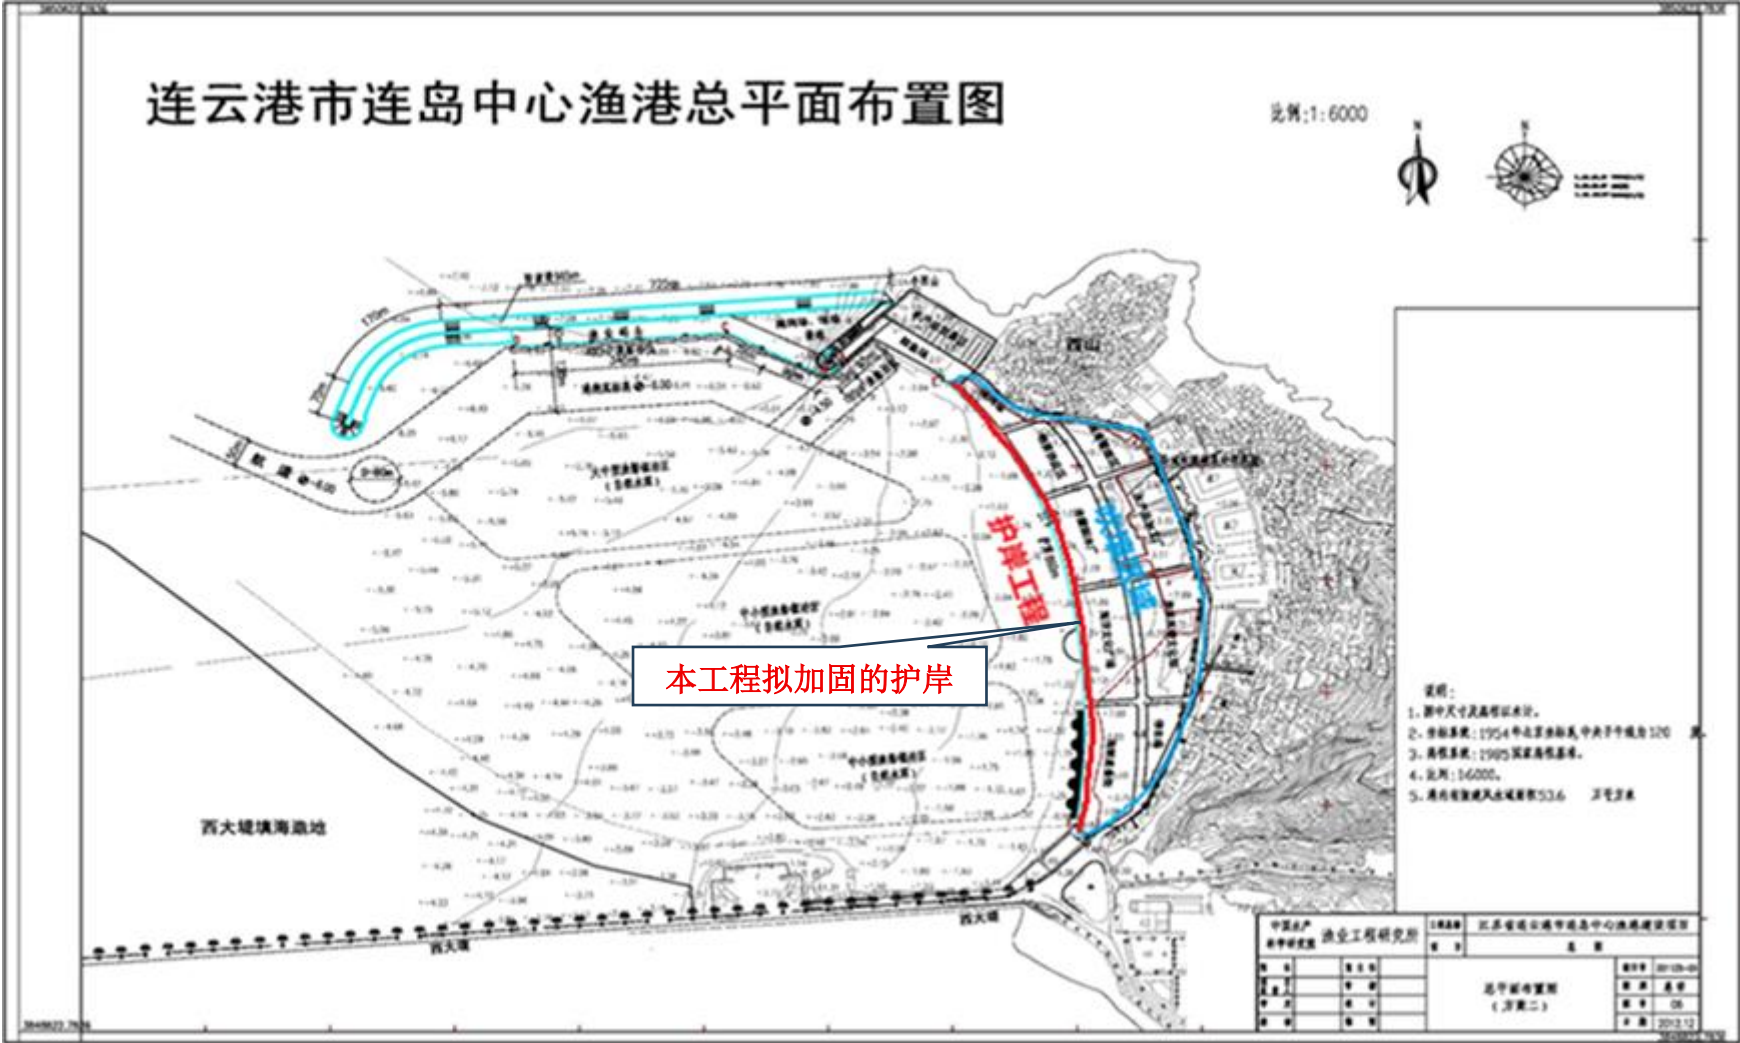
已建连岛中心渔港建设项目总平面布置图 (图中红色为护岸, 蓝色为填海工程)
